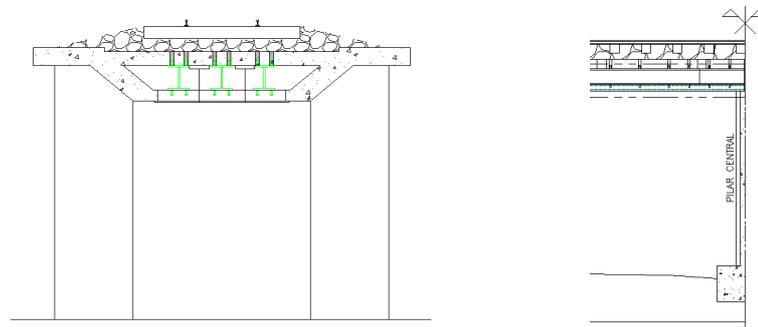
Reforços na estrutura da OAE para garantir utilização do TB-360.
